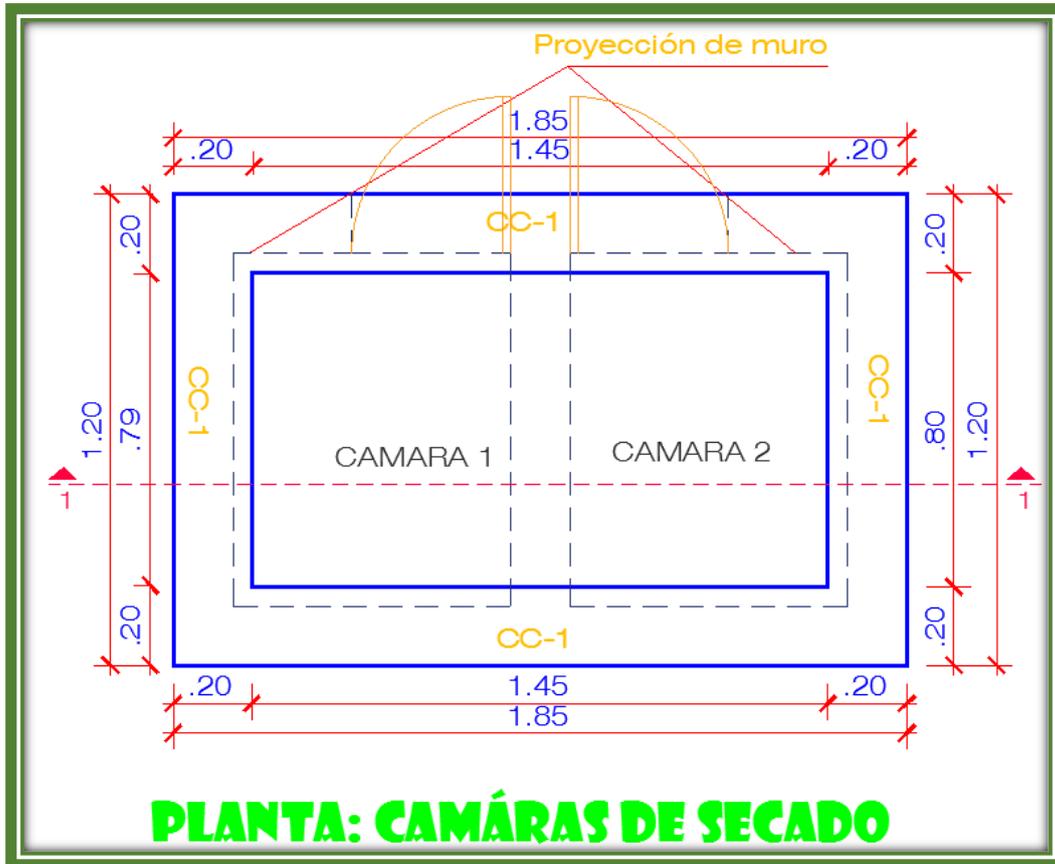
PLANOS DESARROLLADOS EN AUTOCAD DEL SEGUNDO BES
